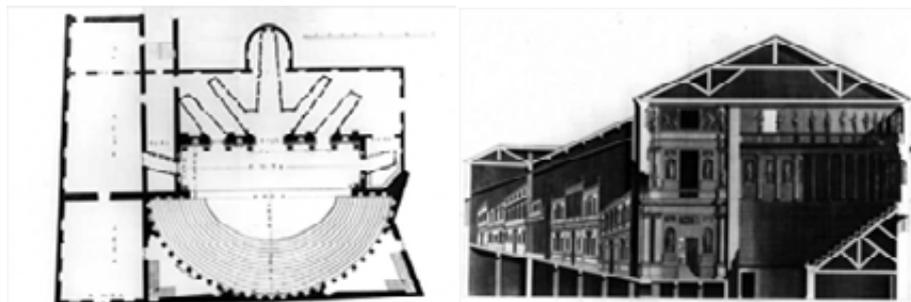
Planta y sección del Teatro Olímpico, Vicenza. Palladio y Scamozzi.
